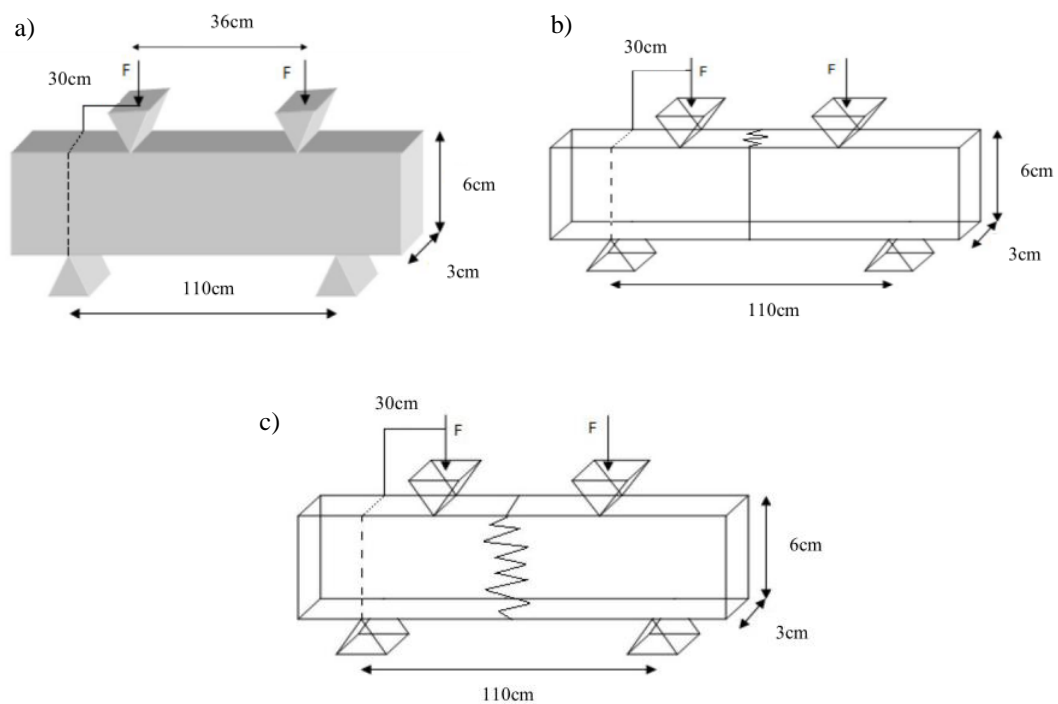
Caractéristiques géométriques de la poutre : a) sans joint, b) avec entures à plat, c) avec entures sur face.
